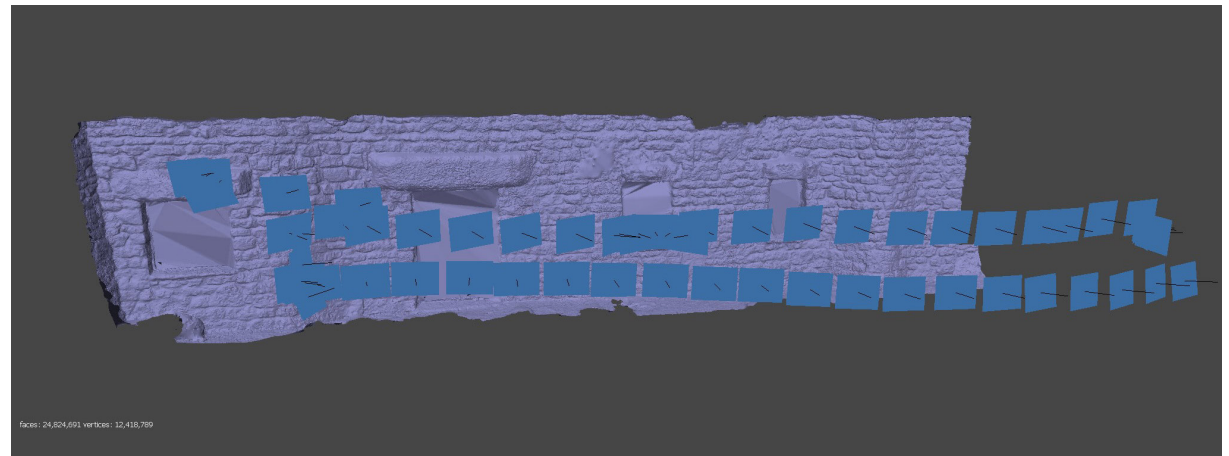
Levantamiento de la fachada nueva. Modelo sólido y posicionamiento de cámaras. Fuente: Elaboración propia
